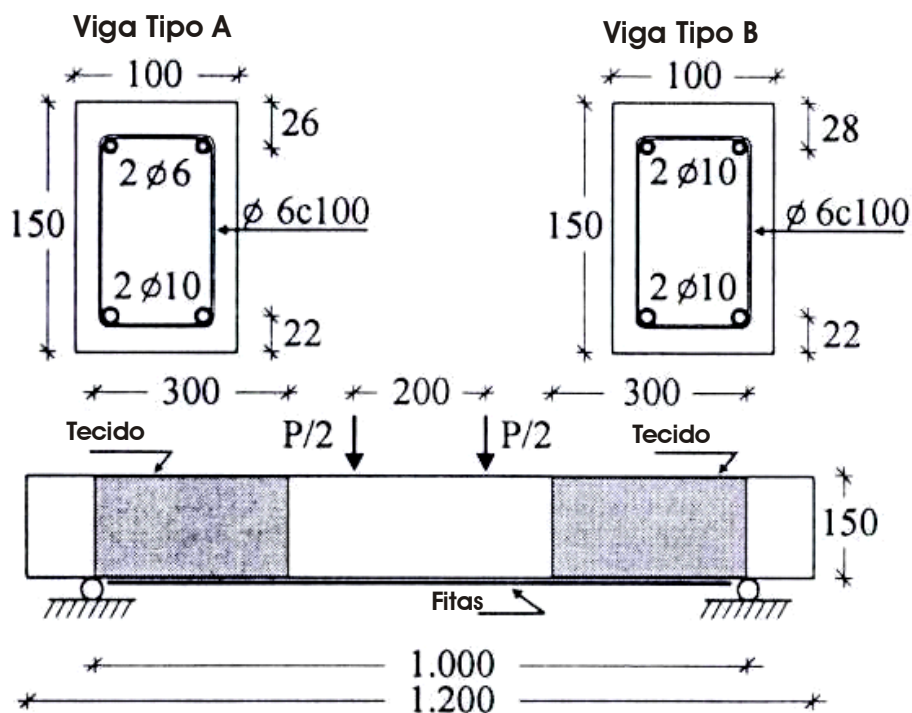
Detalhamento das vigas ensaiadas; adaptada de PARRA e BENLLOCH (2001).
